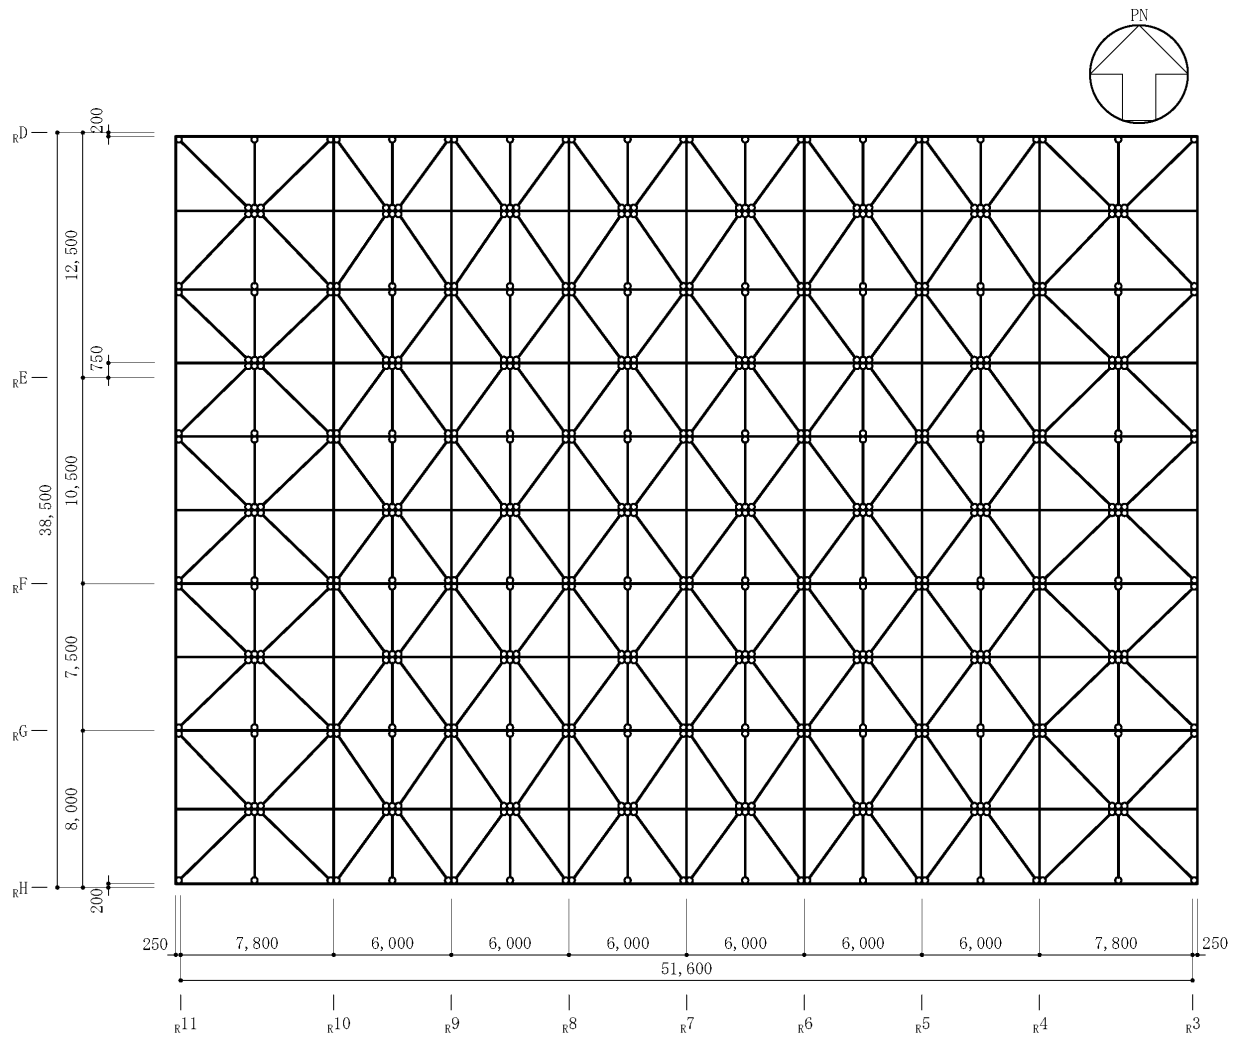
屋根トラス平面 解析モデル図 (はり要素及びトラス要素)
